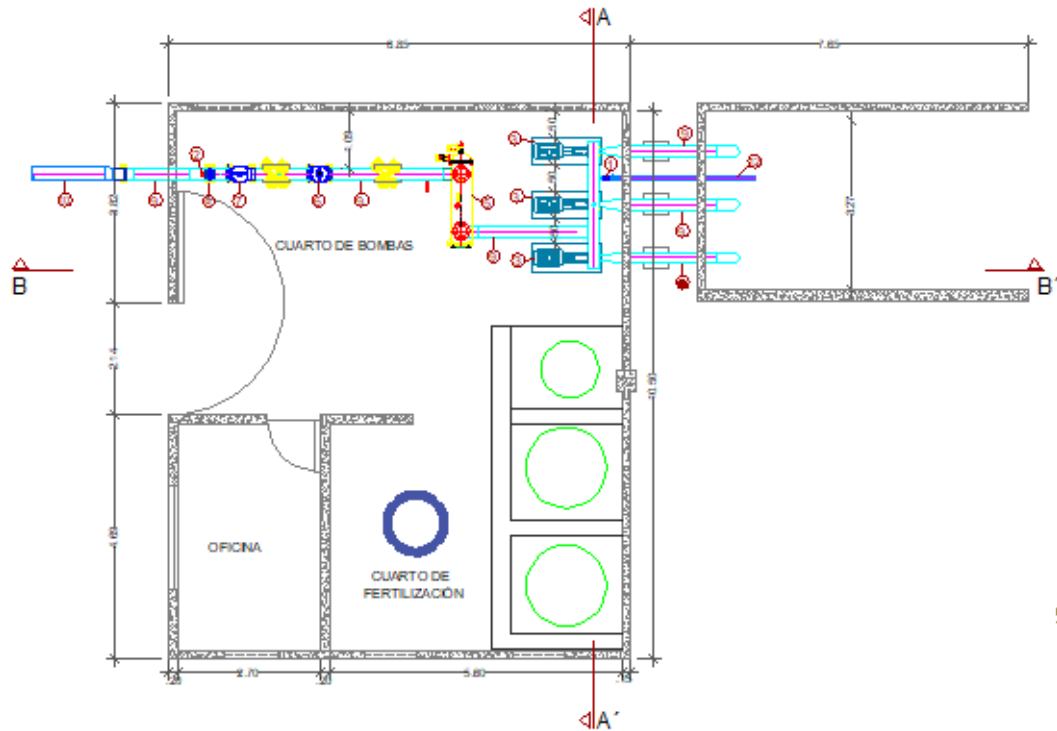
Vista en planta de caseta de riego (Fuente: Elaboración propia)
